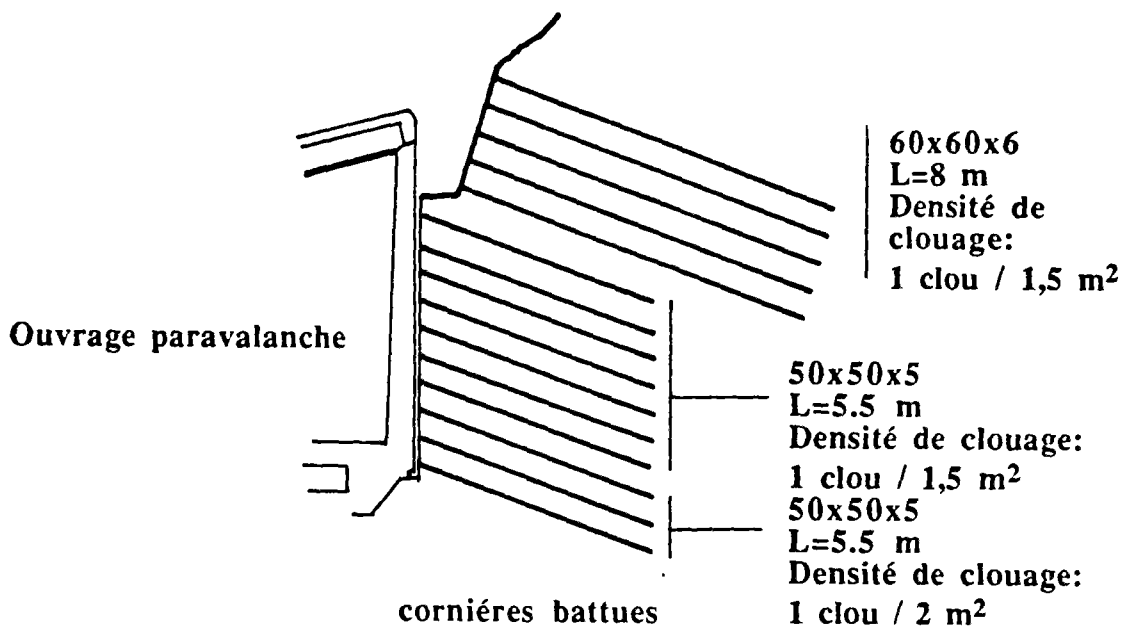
Coupe type du soutènement de l'ouvrage paravalanche. Dans la section représentée, les barres sont battues.
